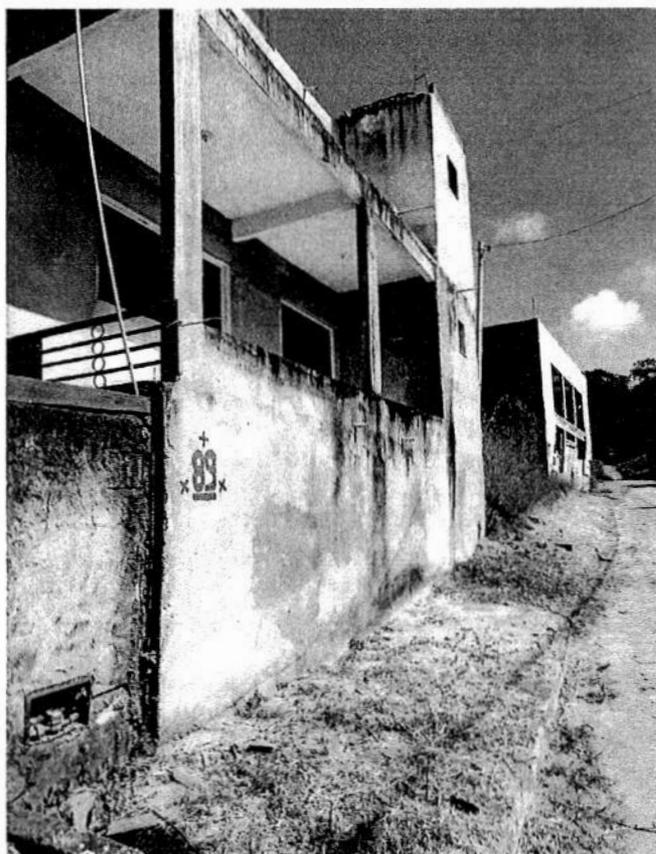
Fachada da casa n° 89 em 03/03/2022
